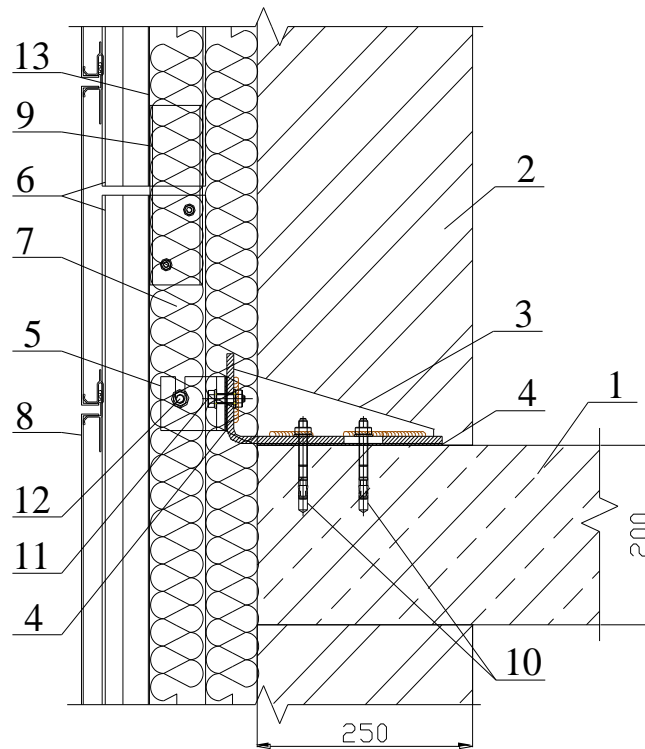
Облицювання фасаду будівлі системою вентиляованого фасаду:
